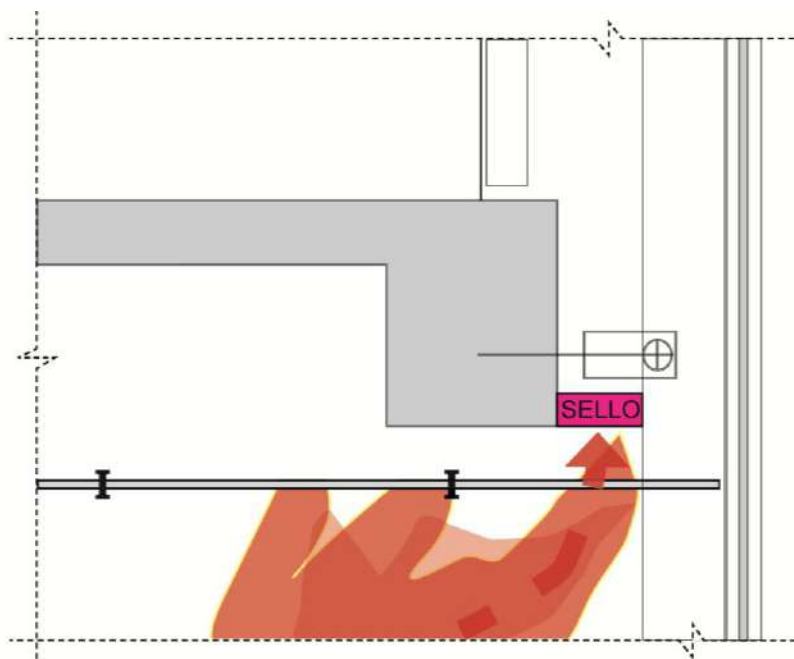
Ejemplo de sello cortafuego en la fachada
